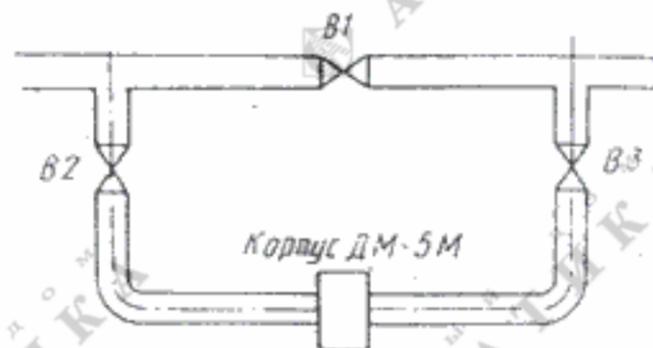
Схема врезки арматуры ДМ-5М на обводном трубопроводе
